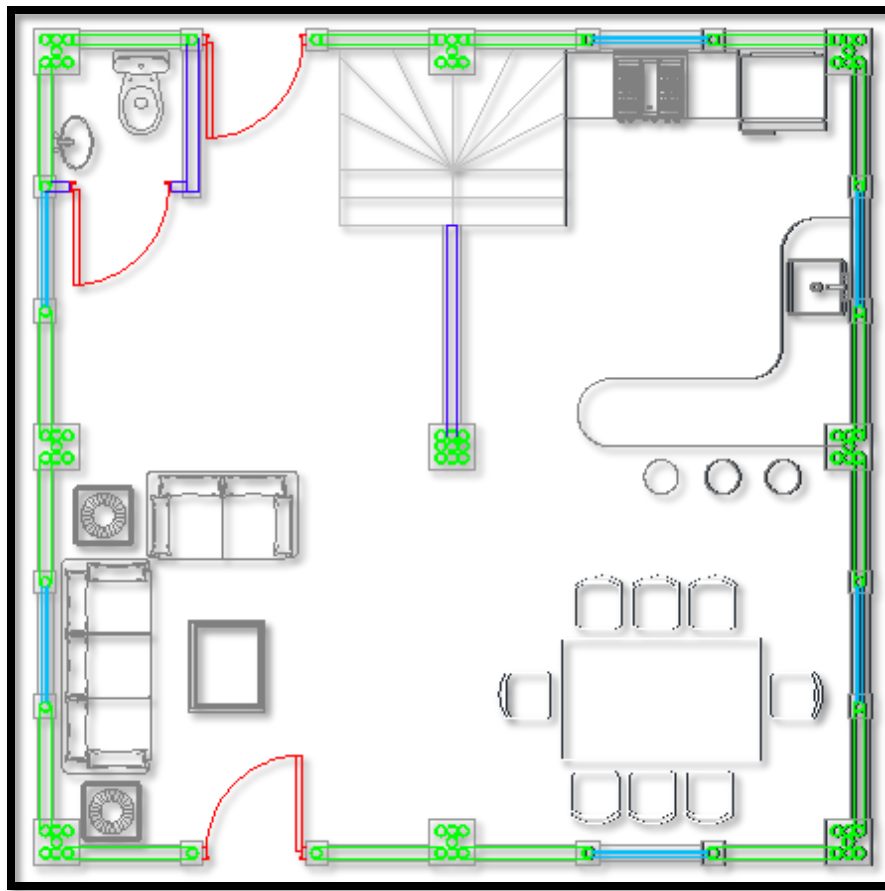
Distribución arquitectónica de la vivienda (Planta Baja).
